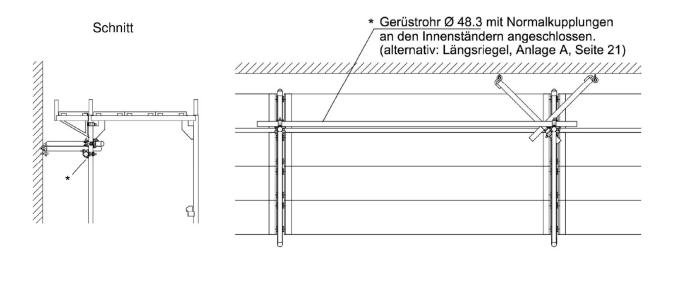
V-Anker mit Gerüstrohraussteifung
